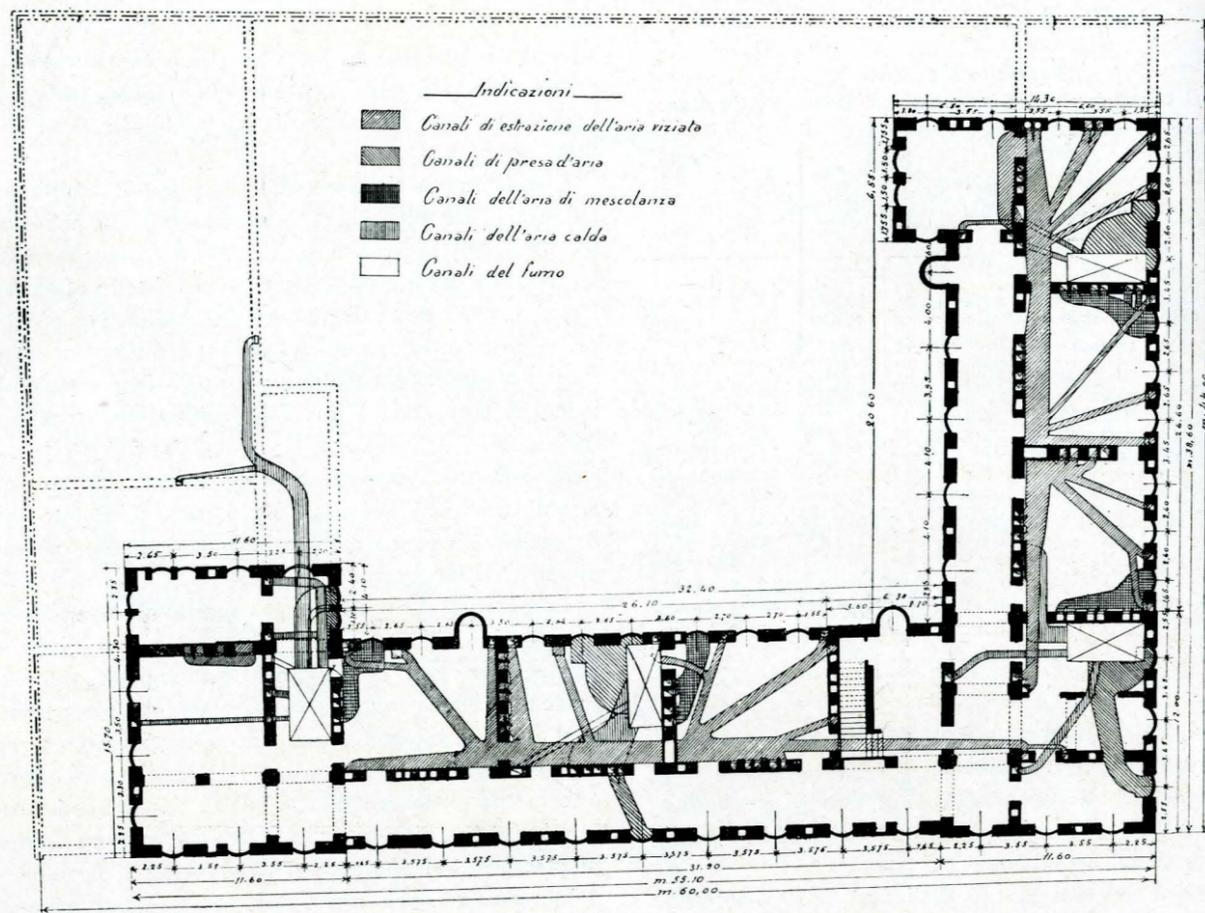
Pianta del piano sotterraneo. — Scala 1 : 400.
